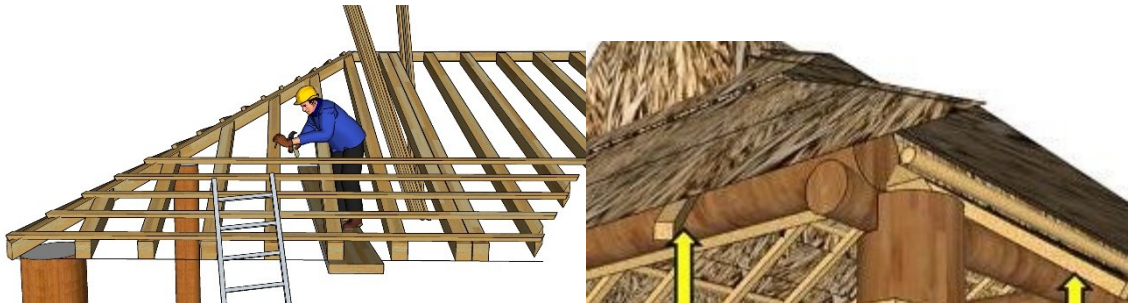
Procesos de construcción que se usaran para el proyecto.
